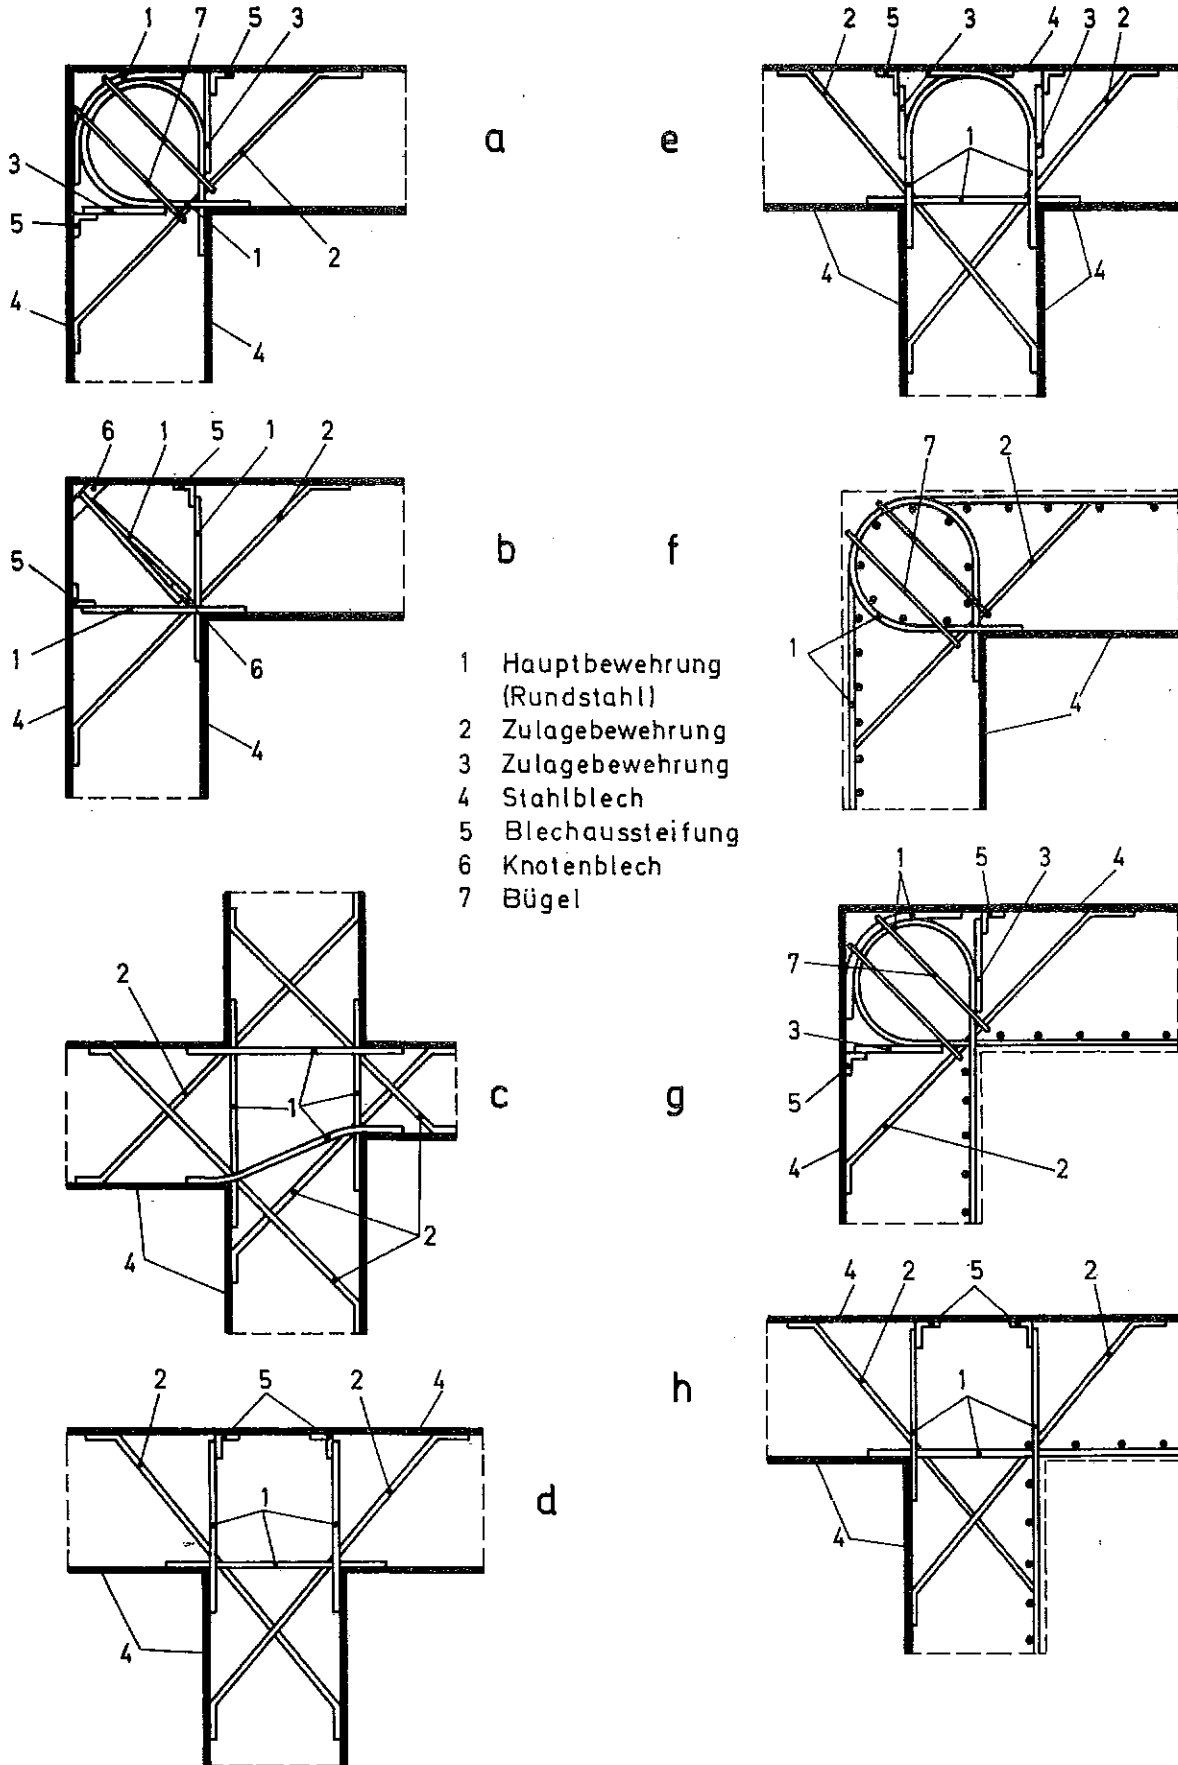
Bewehrungsführung bei Wandecken (Schweißnähte nicht dargestellt)
